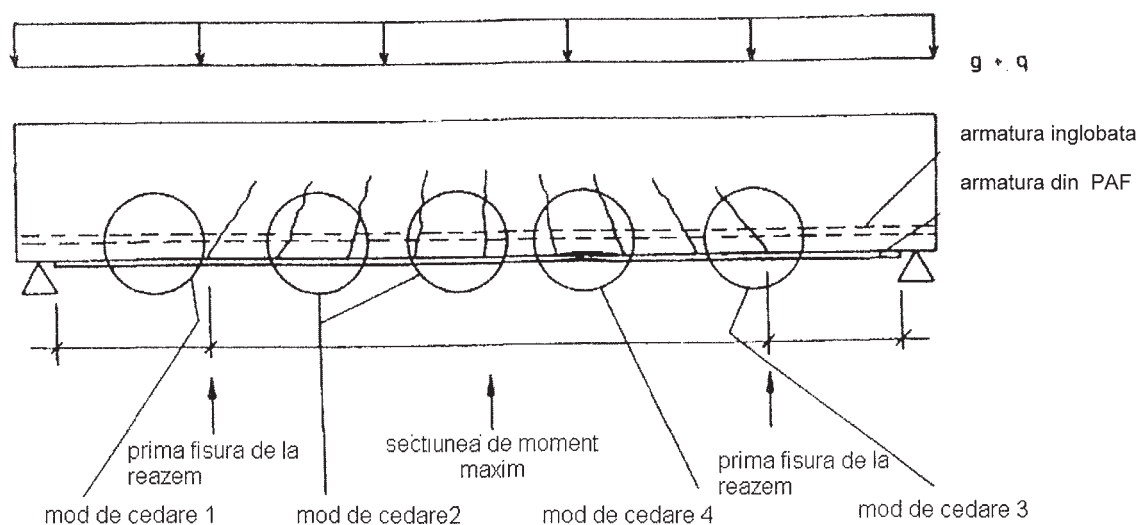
Moduri de cedare a unui element de beton consolidat cu armătură tip PAF
